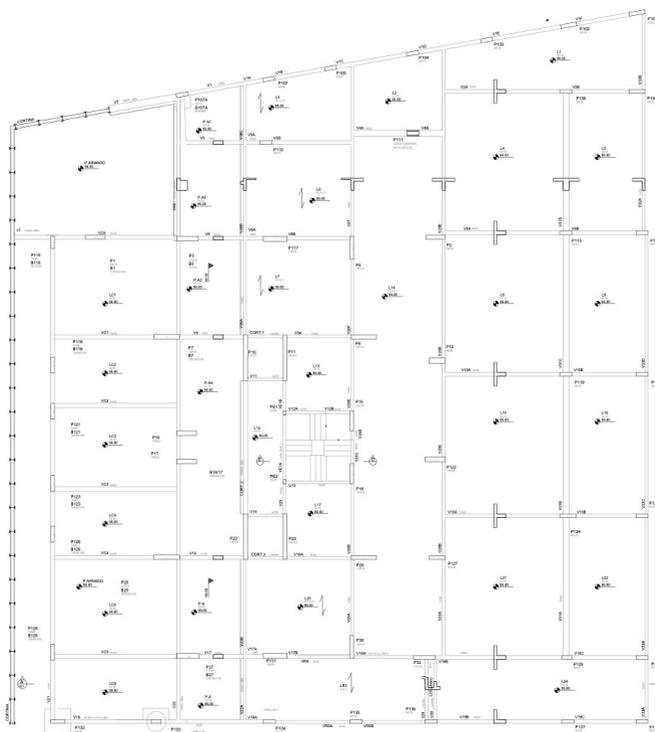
Planta de fôrma – 1º subsolo (teto 2º subsolo).
